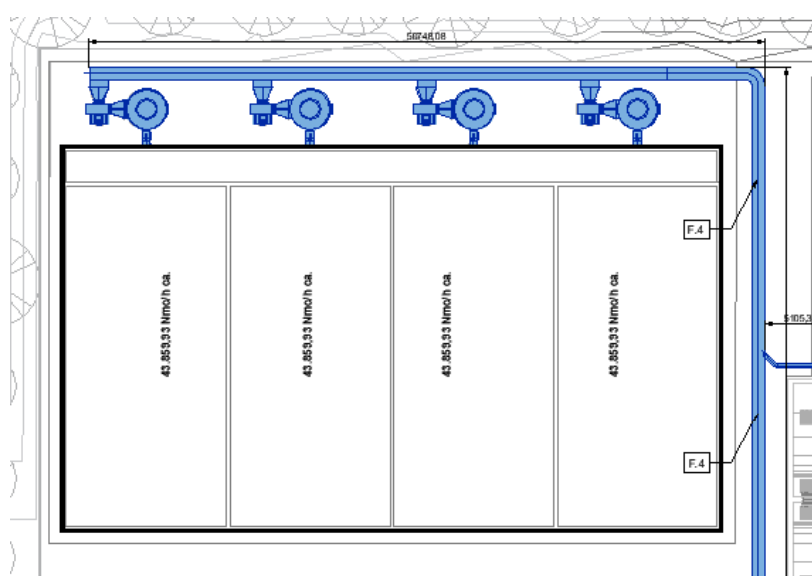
planimetria dell'area di biofiltrazione in progetto
